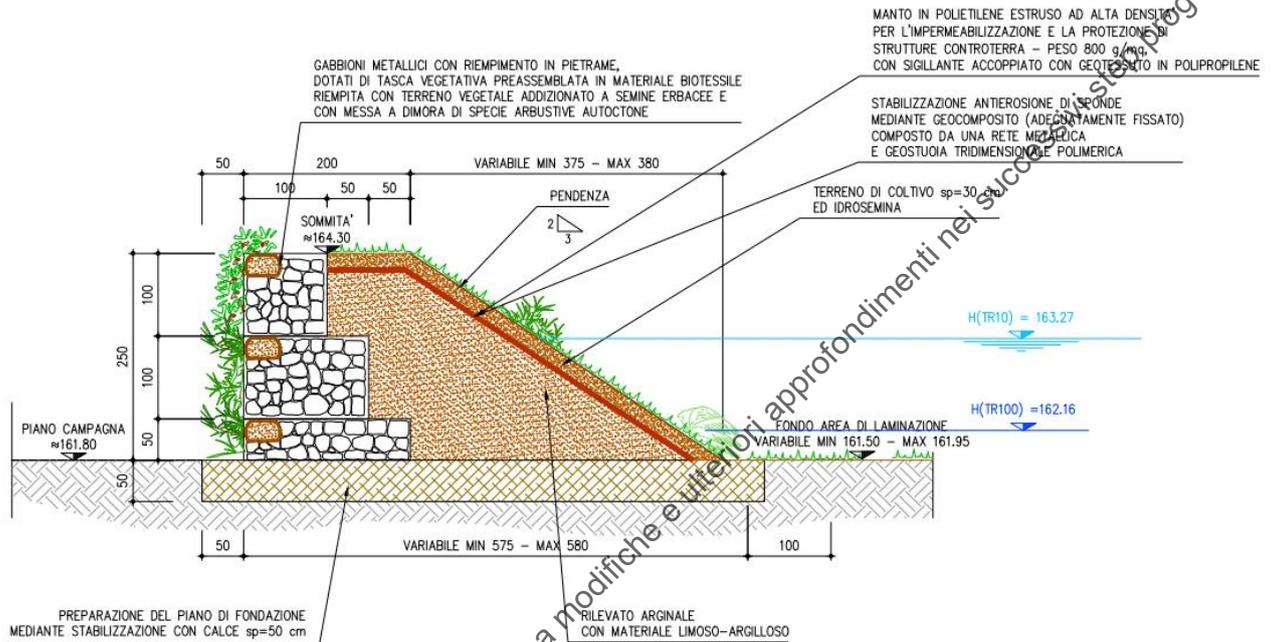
sezione tipo 3, Area di laminazione A. Estratto da Tav. 10
